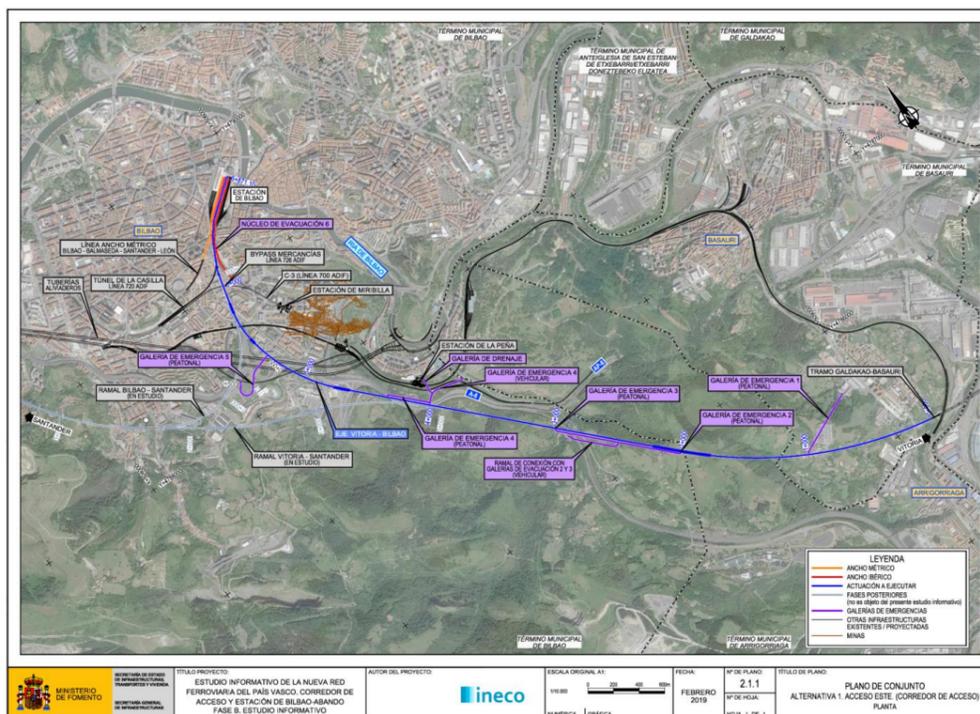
Planta de conjunto de la Alternativa 1 propuesta (E.I. NRFPV 2019)
